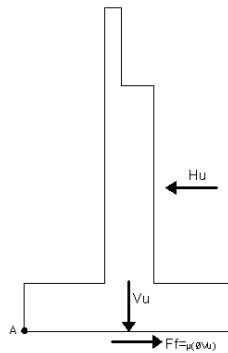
42 Carga actuante en base de estribo por deslizamiento
